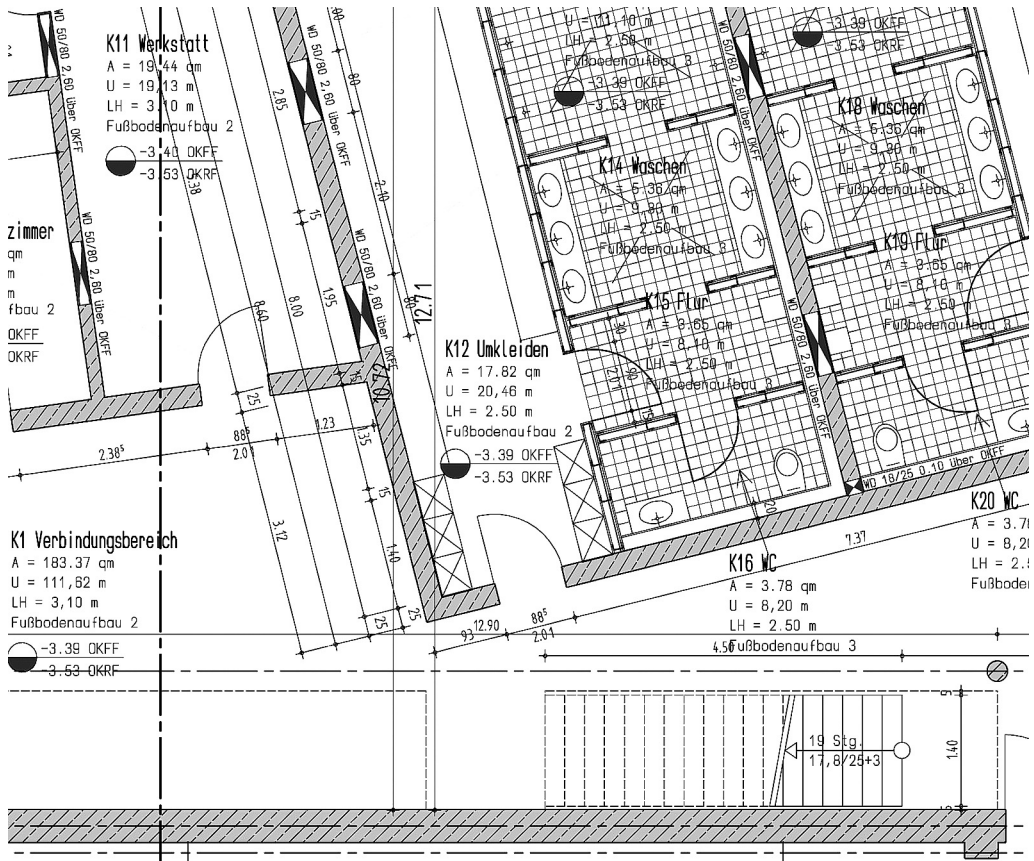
Ausschnitt aus einem Ausführungsplan M 1:50.
